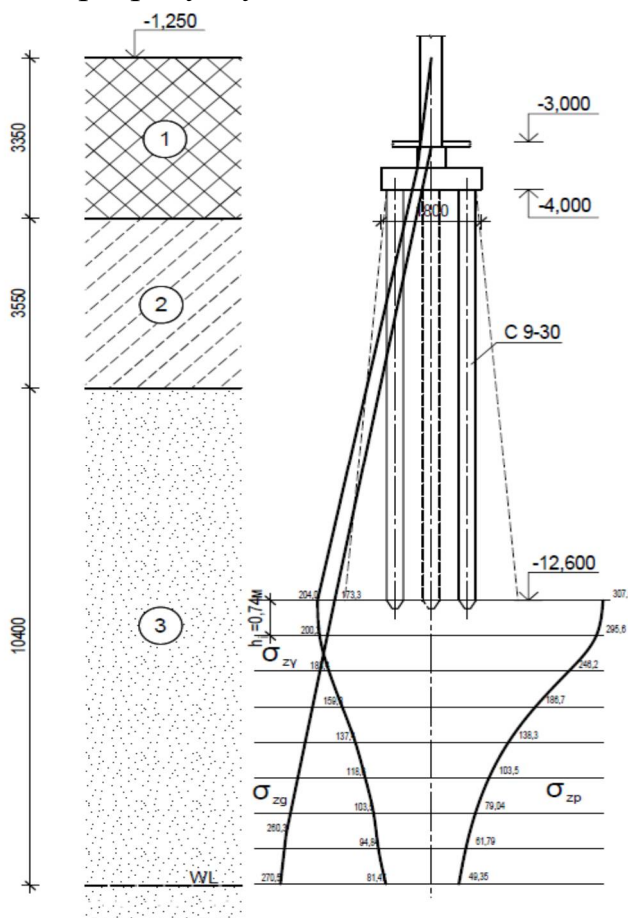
Схема розрахунку осідання пального фундаменту
